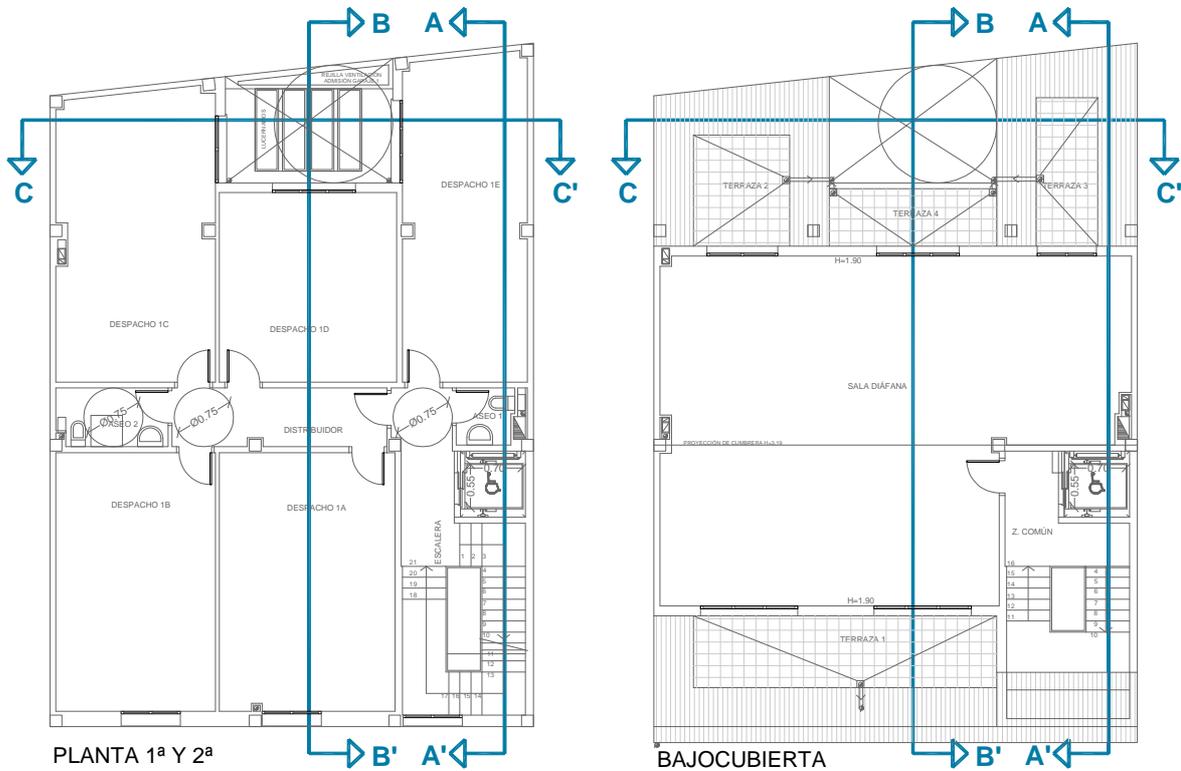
Plantas 1ª, 2ª y Bajocubierta
